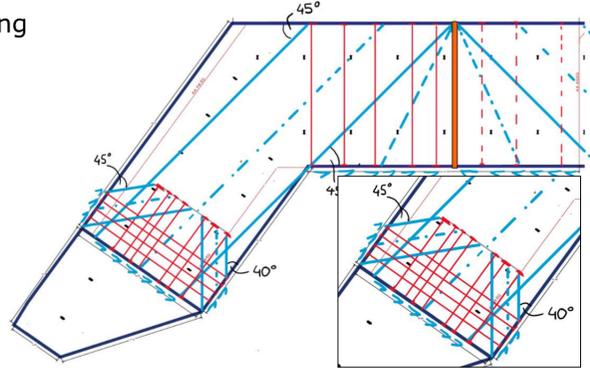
Lastausbreitung in der Einstellhallendecke mit Spannungsfeldern: Variante 1
